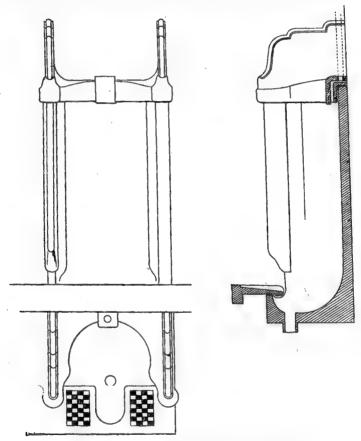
et 6. - Installation des urinoirs, en plan et en coupe.
